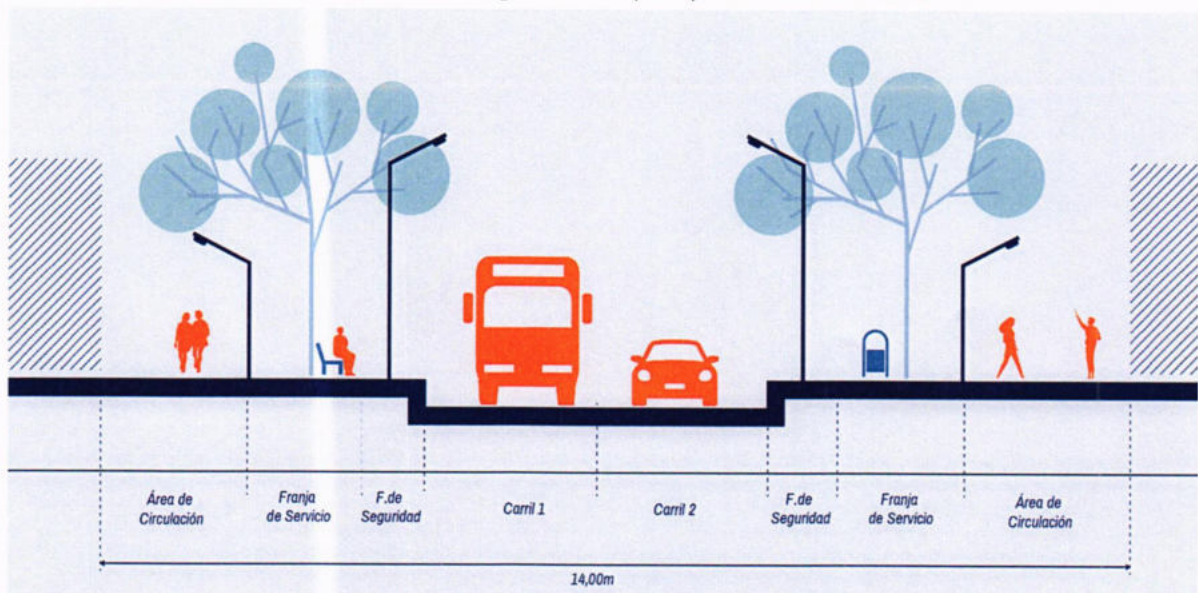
Vía interna longitudinal 5 (ViL5) del Plan Villanueva Fase 2A
